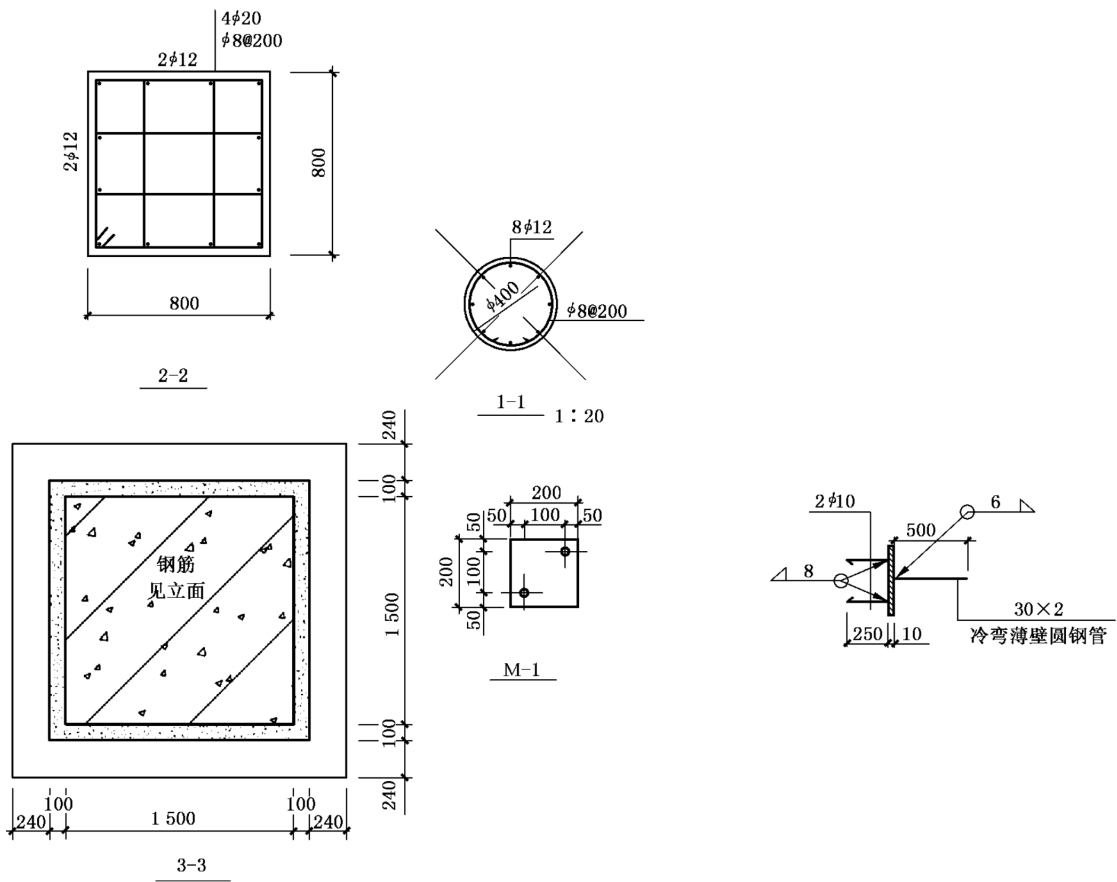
土层混凝土观测墩设计俯视剖面图(示例)
